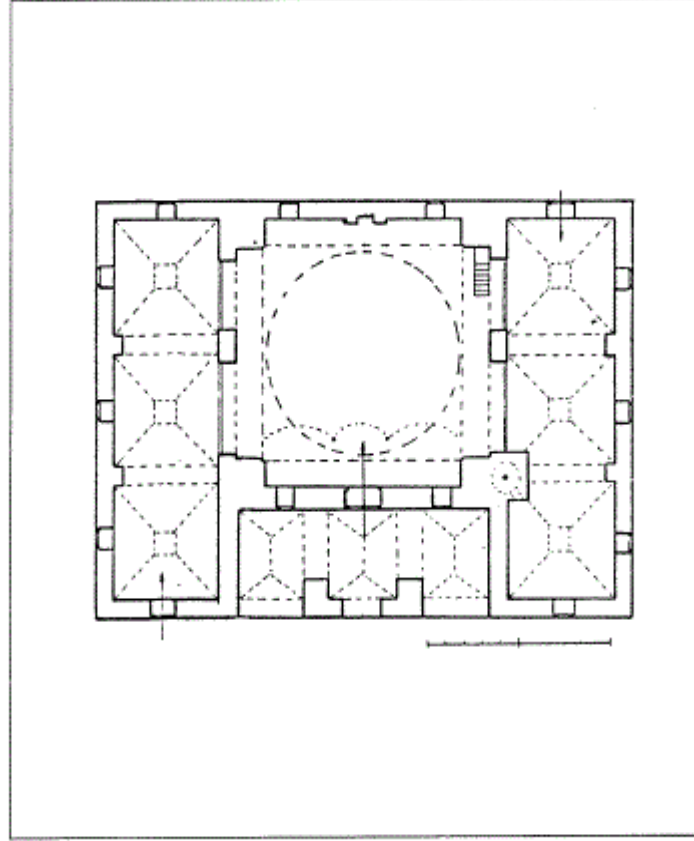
مسقط أفقي لمسجد السوق في Gjirokastra (عن : كبل).
